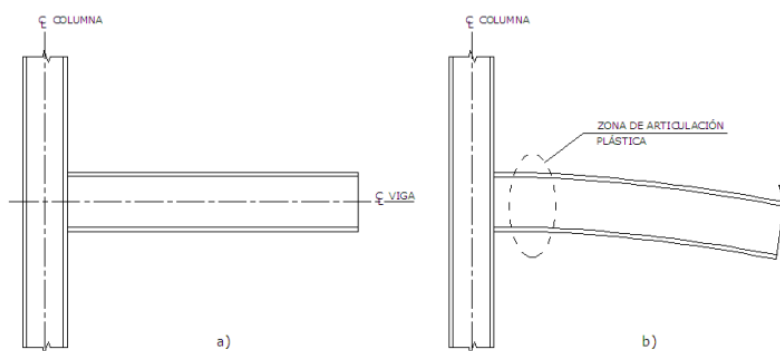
Comportamiento dúctil, rotula plástica en la viga
